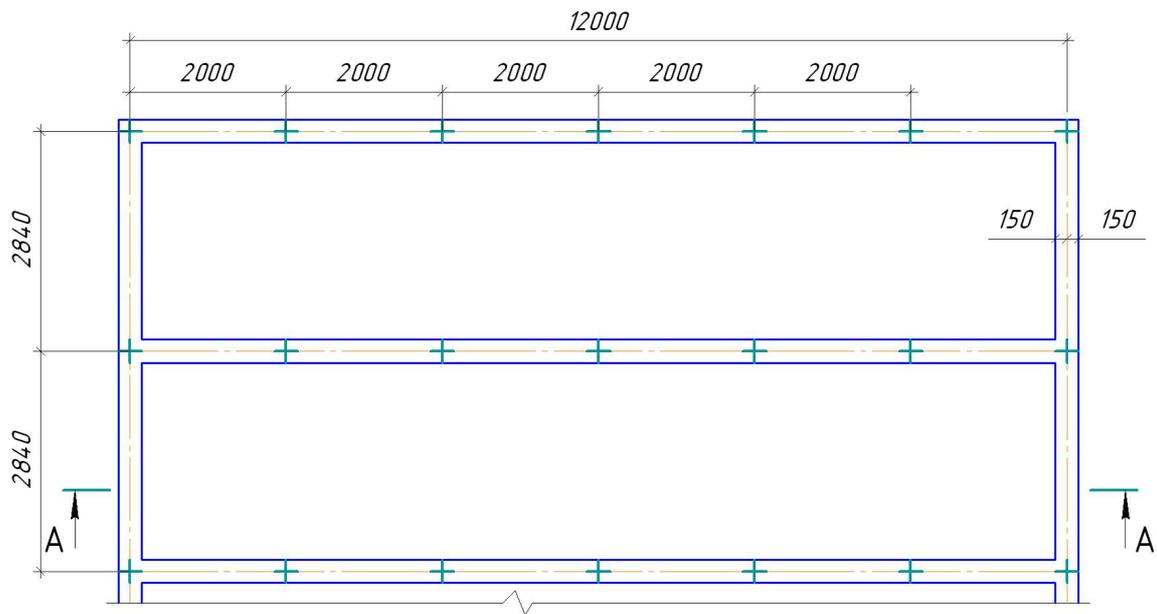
Схема плана ростверка под модульное здание длиной 12 м
